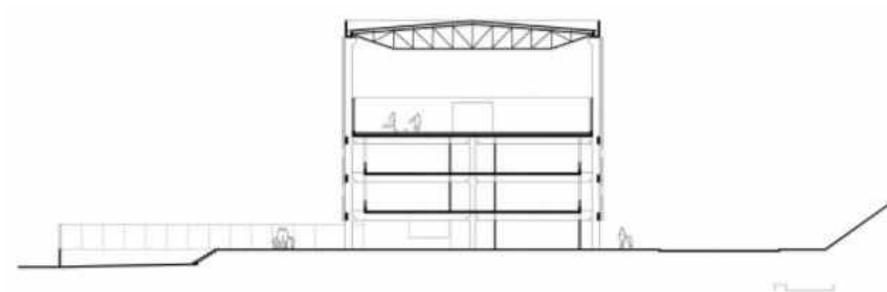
Escola em Campinas - corte transversal. Fonte: Una Arquitetos
